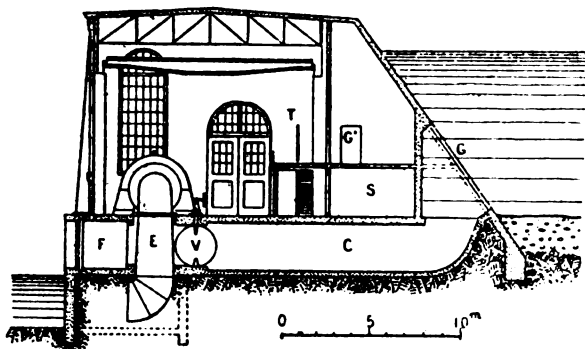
Sezione della Centrale di Oakdale, Tippecanoe.
